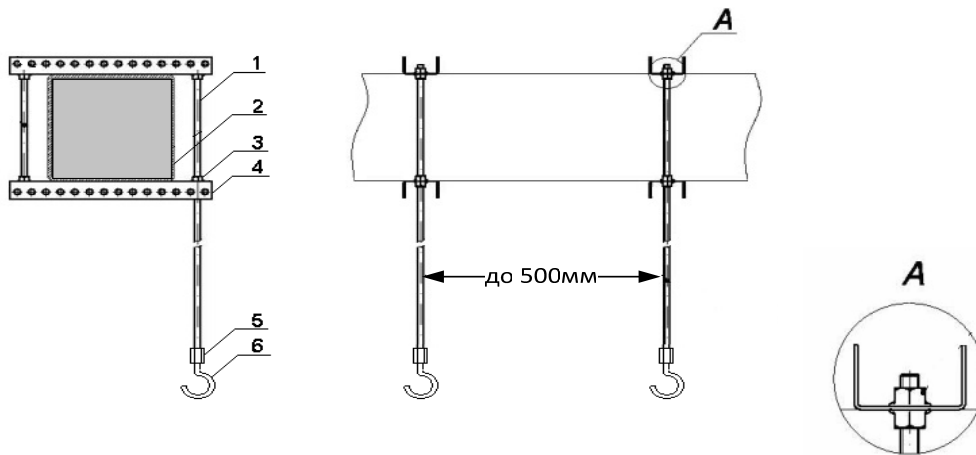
Пример крепления ОКЛ на металлическую балку
